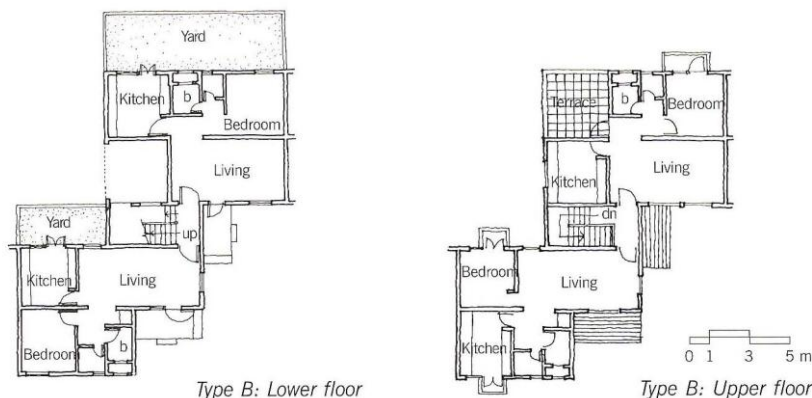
Planos de planta baja y 1ª planta. Tipología B
